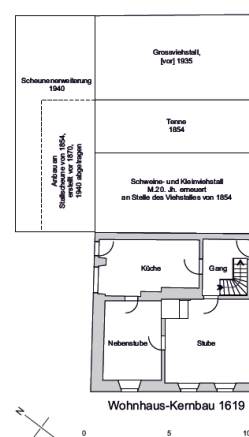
Grundriss Erdgeschoss, 1:200.
